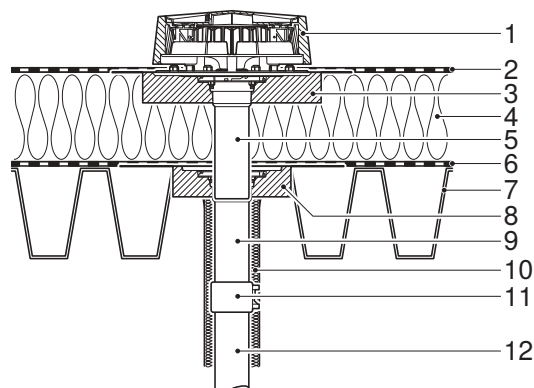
Montage dans toiture en bac d'acier isolée avec revêtement d'étanchéité et raccord au pare-vapeur
